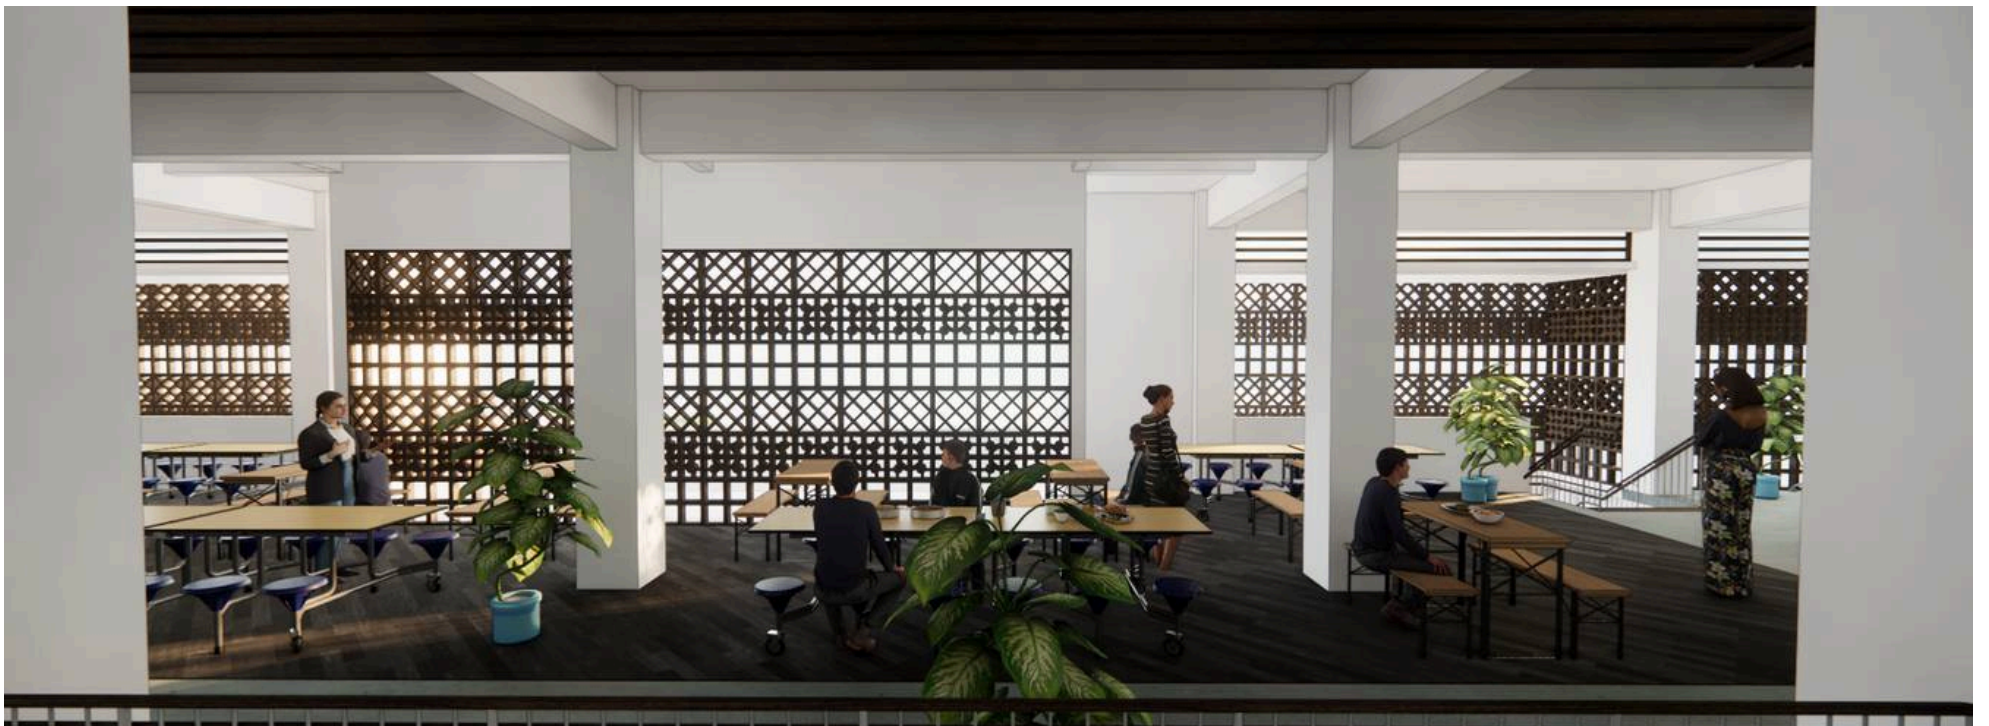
Area Kios Pangan Kering & Non Pangan
